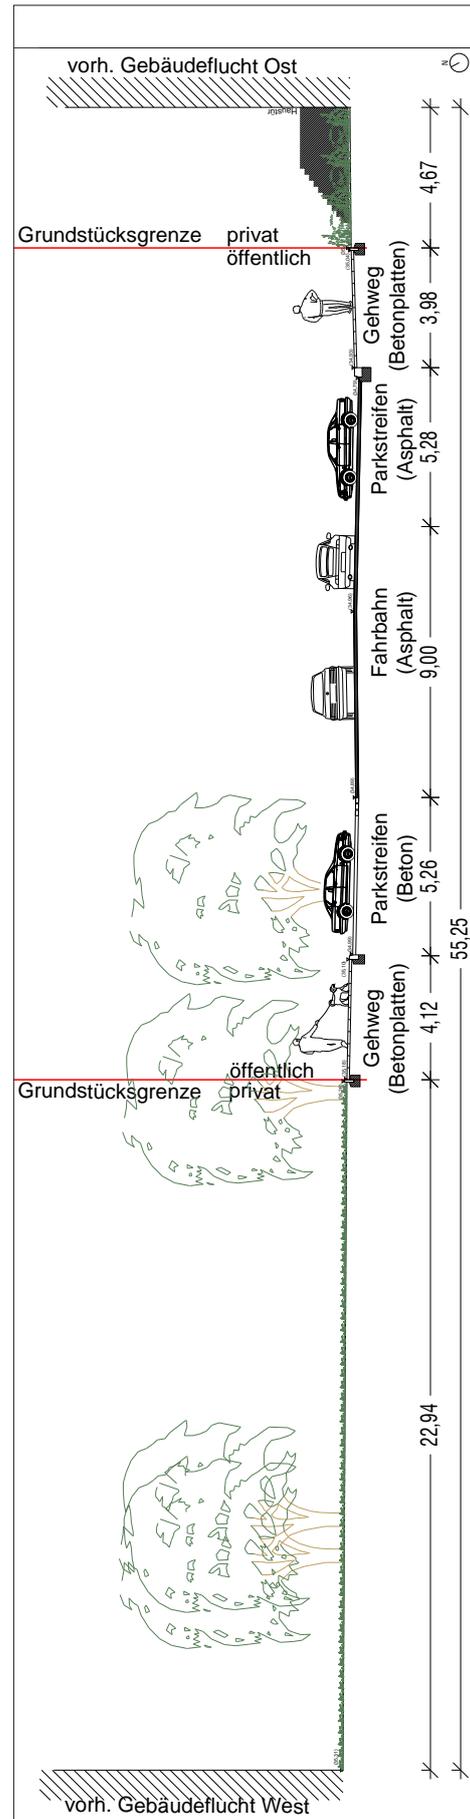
Straßenquerschnitt einschließlich privater Grünfläche Michaelkirchstraße 24-30
